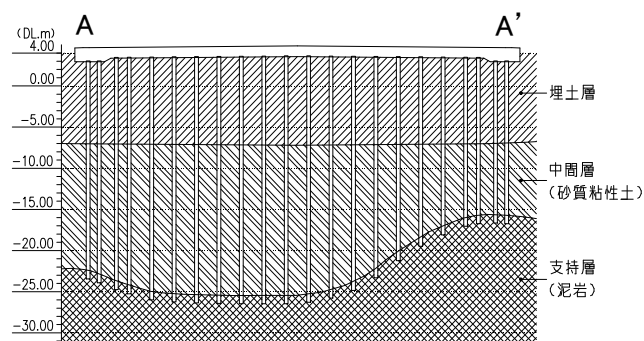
タンクエリアの地盤断面図 (A-A' 断面)
